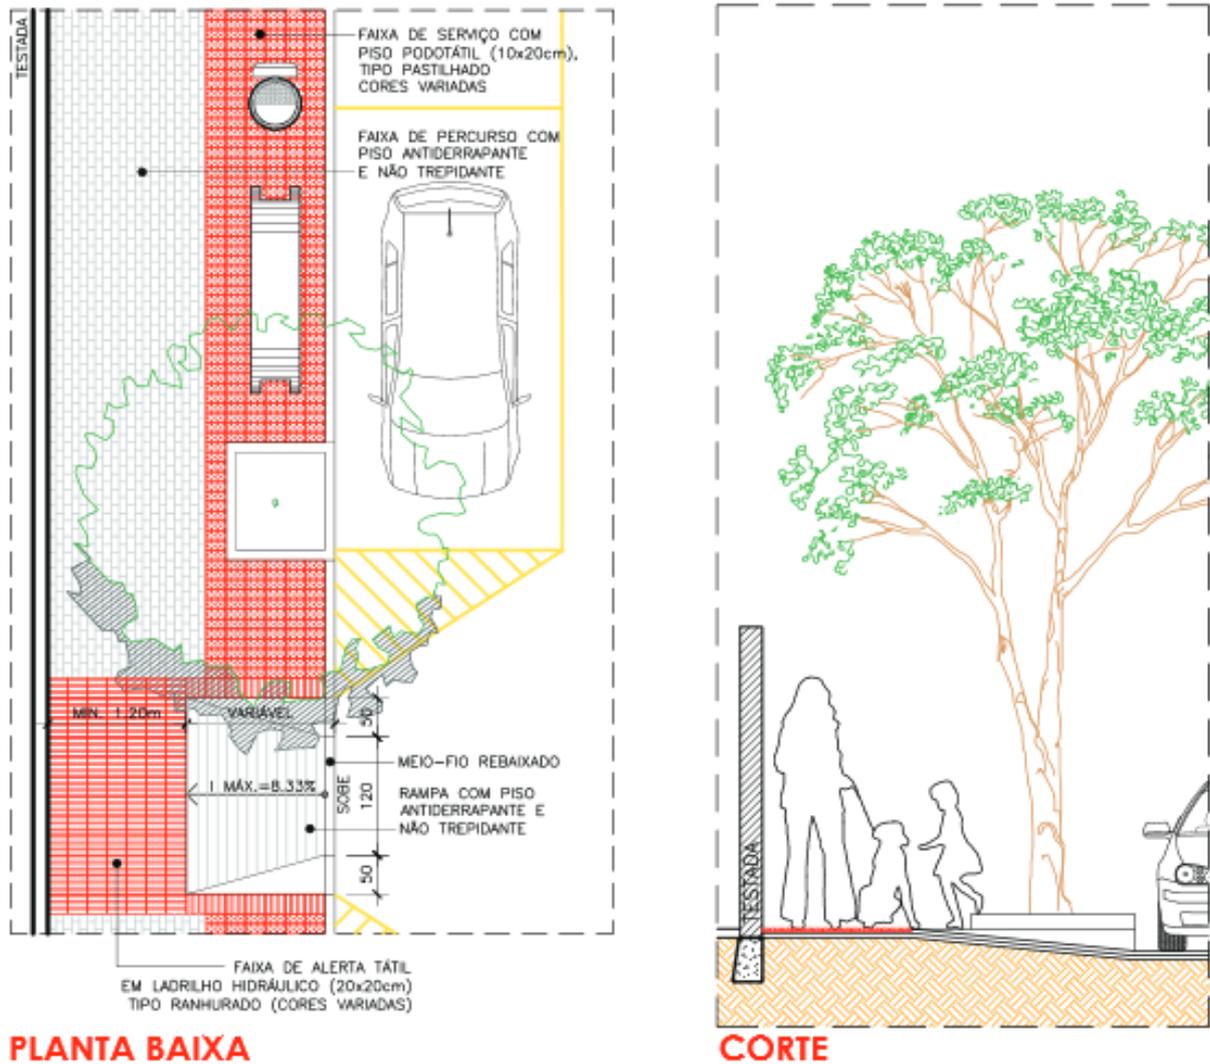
Planta baixa e corte de modelo de rampas para pedestres.
